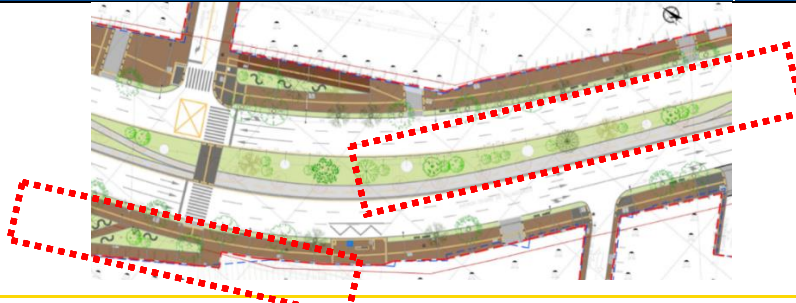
Planta tipológica del arbolado paisaje lineal estructurante
